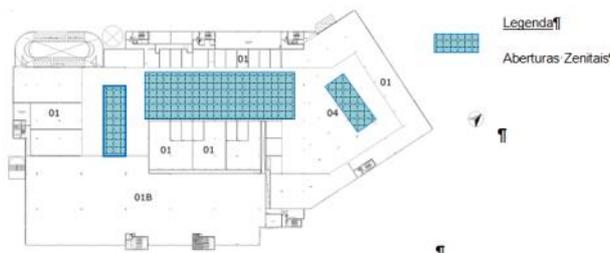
Planta com projeções das aberturas zenitais na cobertura e área de relação de abrangência no 4º pavimento. (Autora)
